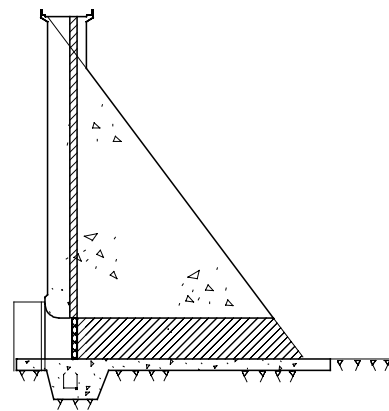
Seção longitudinal de adufa em barragem de concreto a gravidade.
